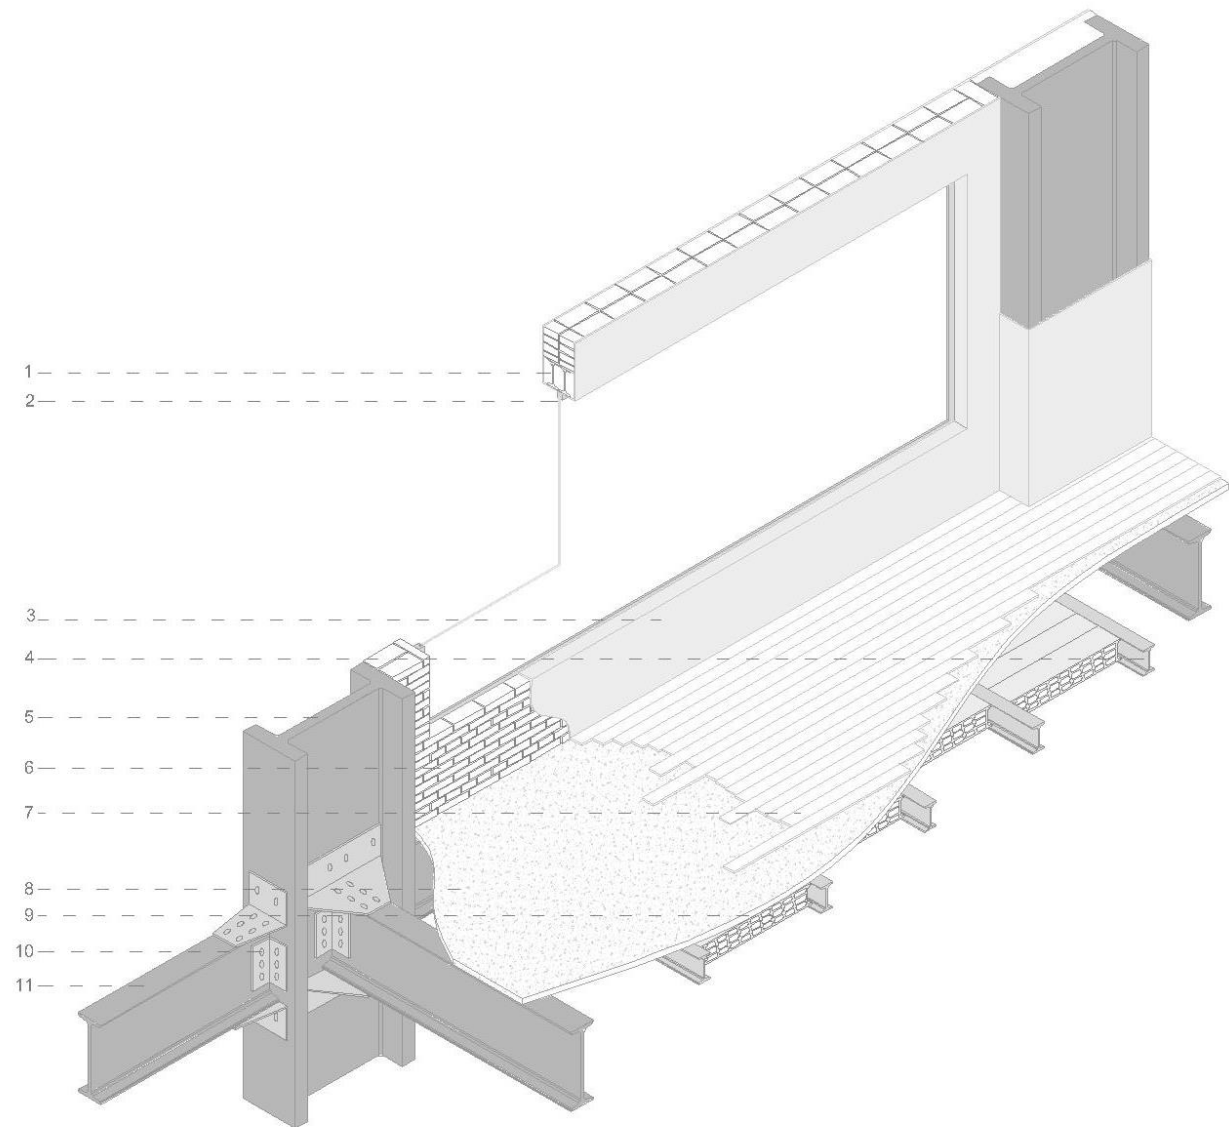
Detalle constructivo tipo de las uniones roblonadas del edificio "Almacenes Carson, pirie, Scott
